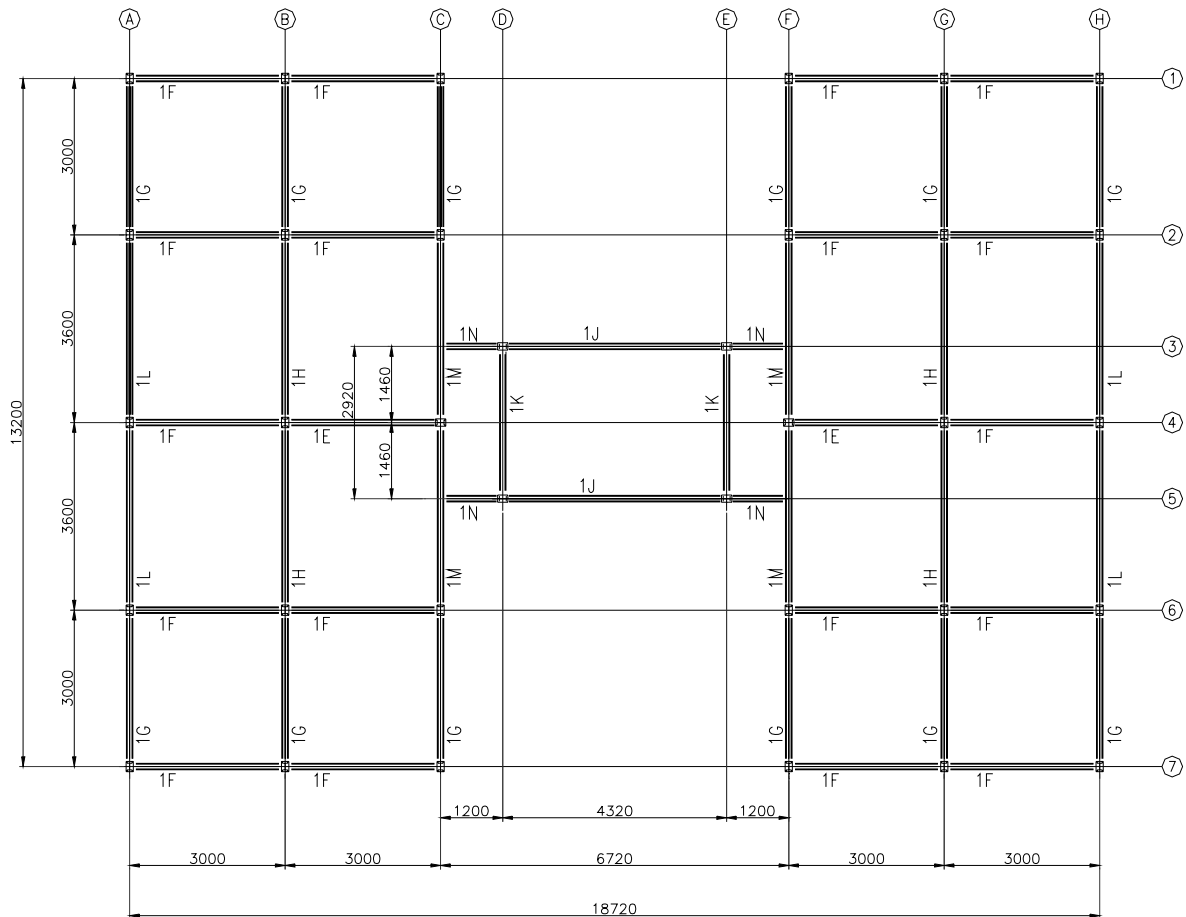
Plano de vigas do pavimento tipo - Aperticado – arquitetura tipo “B”
